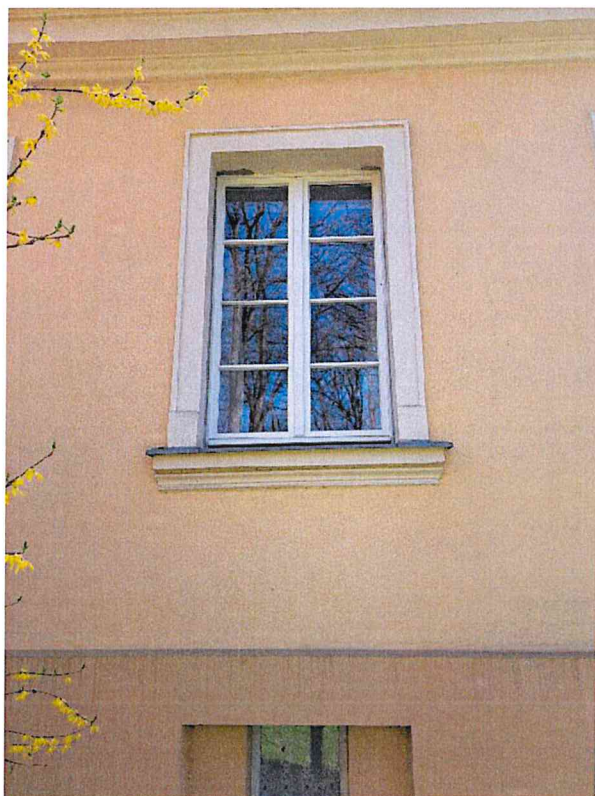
Stan zachowania tynków w obrębie narożnika południowo-wschodniego. Ogólny widok na elewację w kierunku zachodnim.
